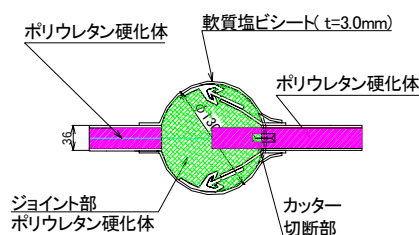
ジョイント部構造図 写真-2 ポリウレタン注入状況
